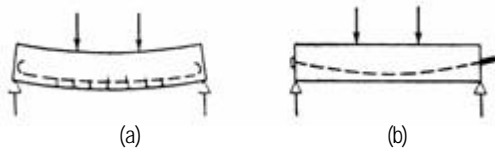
Deformación y agrietamiento en vigas de:
